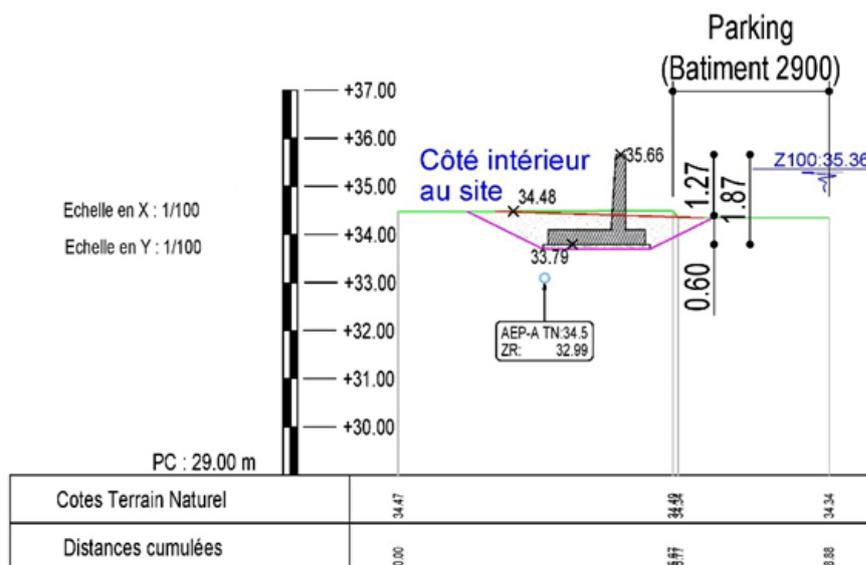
Profil en travers du mur 3 au PK 100.
